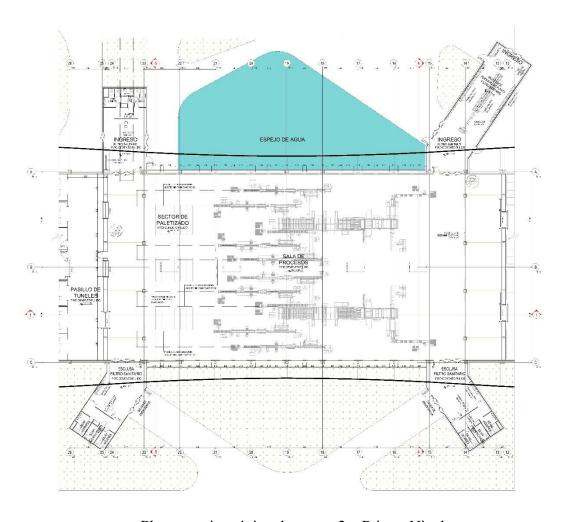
Plano arquitectónico de sector 2 – Primer Nivel.
